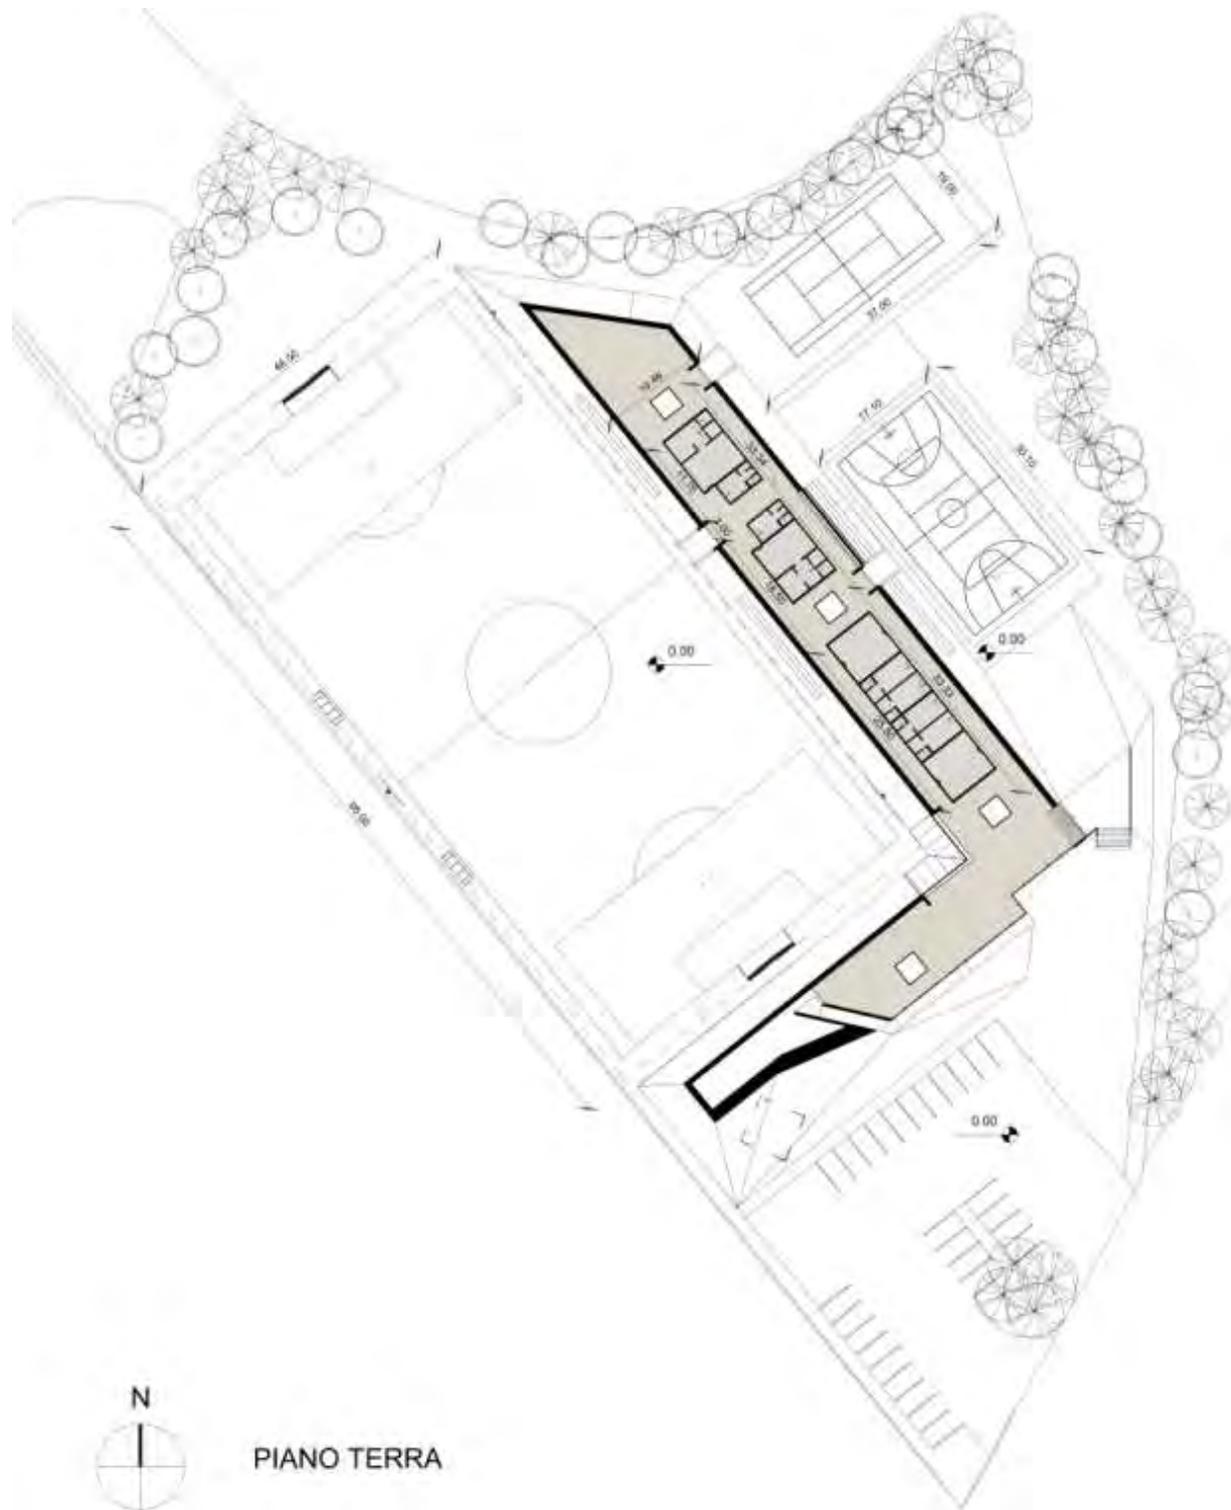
LOTTO B - PIANTE PIANO TERRA
